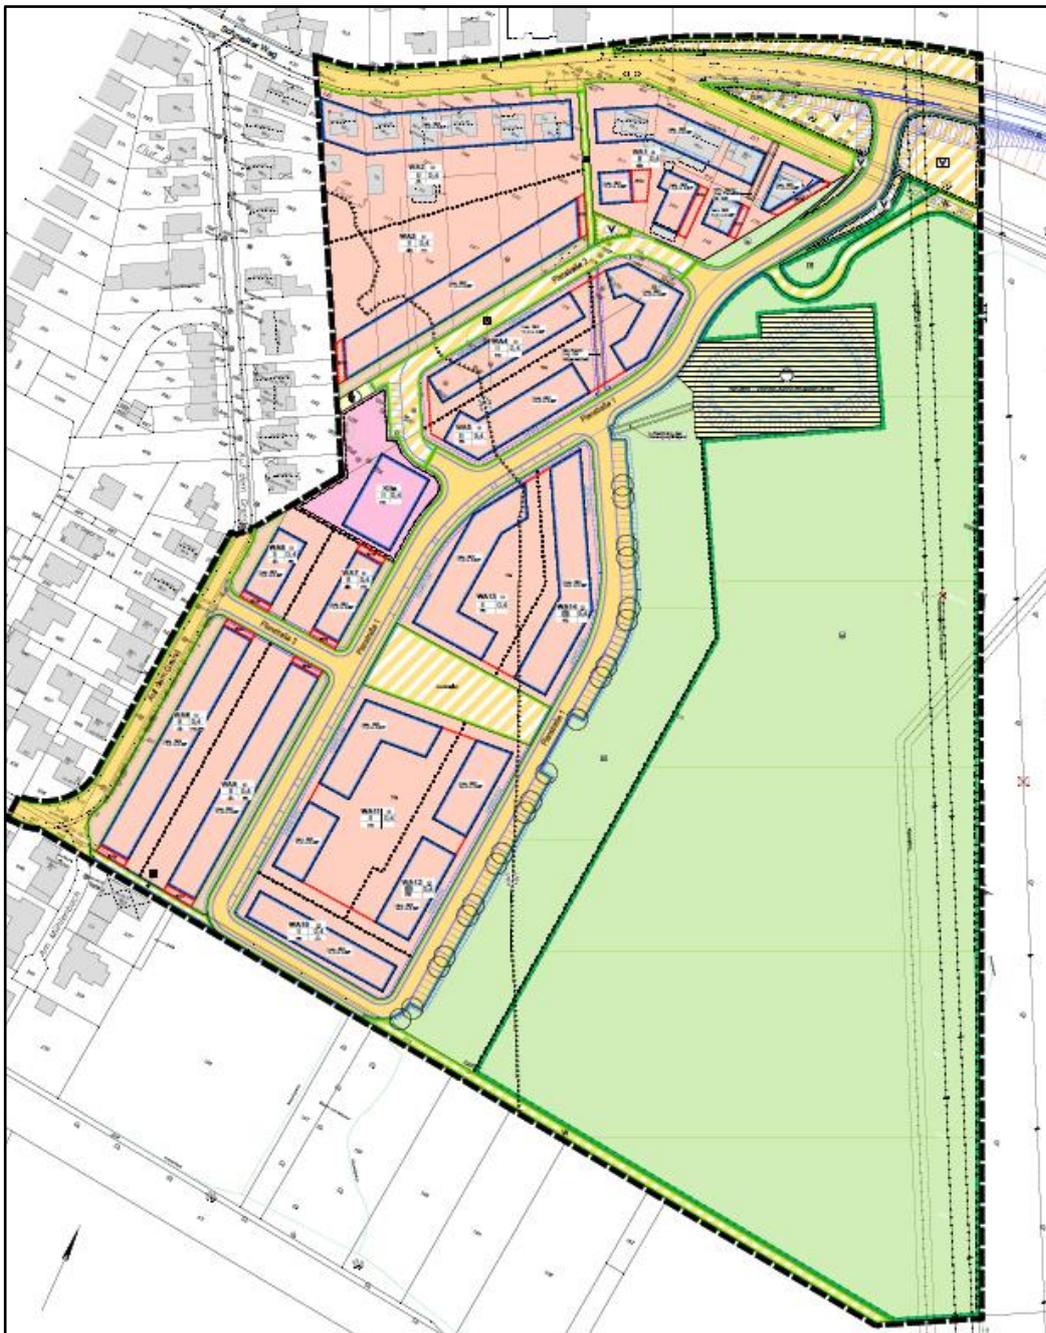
Lageplan des Bebauungsplans S 195
